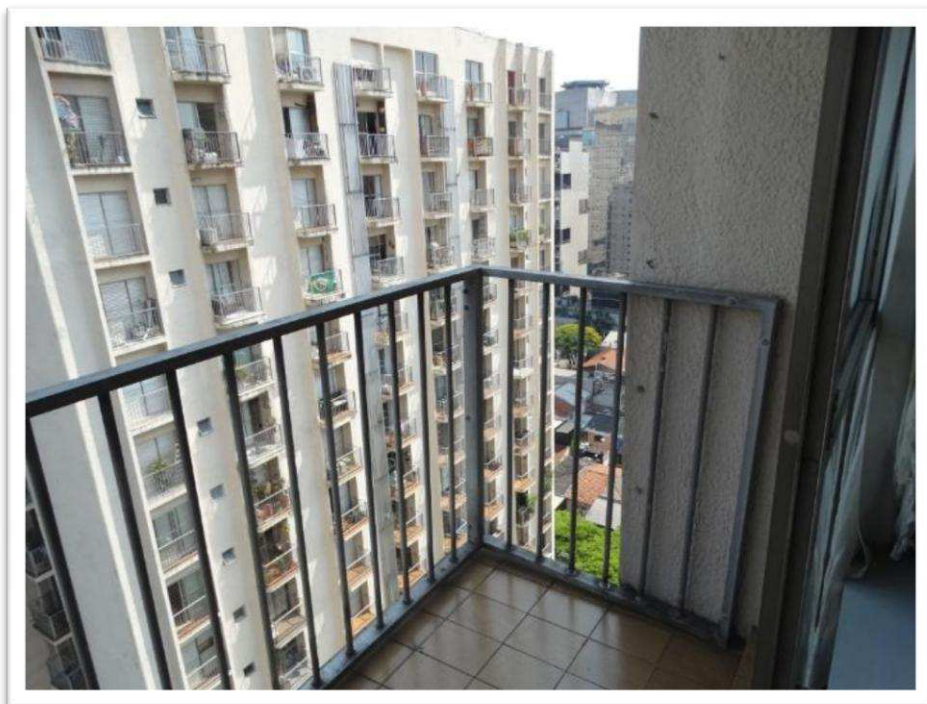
Vista do Apartamento nº 178 do Bloco B – Varanda junto à Sala.
